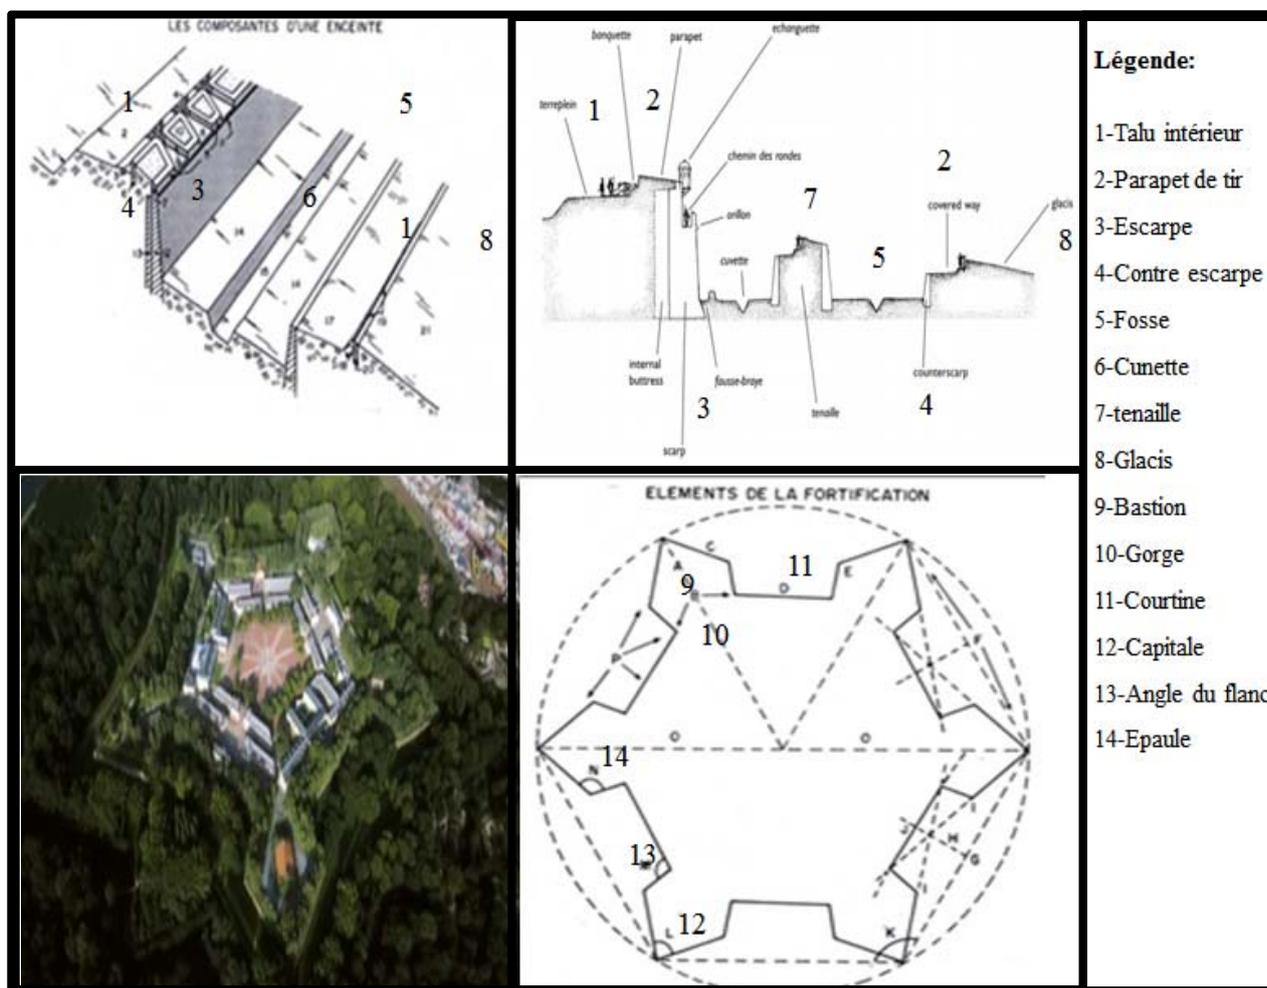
Vue en plan et en coupe d'une citadelle de Vauban
